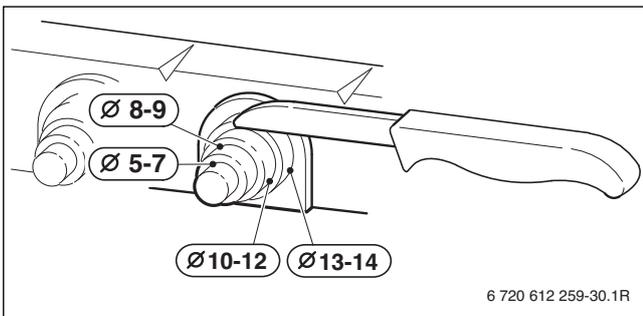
Zugentlastung Kabel Mischermotor anpassen
